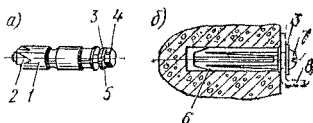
Схемы крепления горизонтальных воздуховодов к перекрытию
